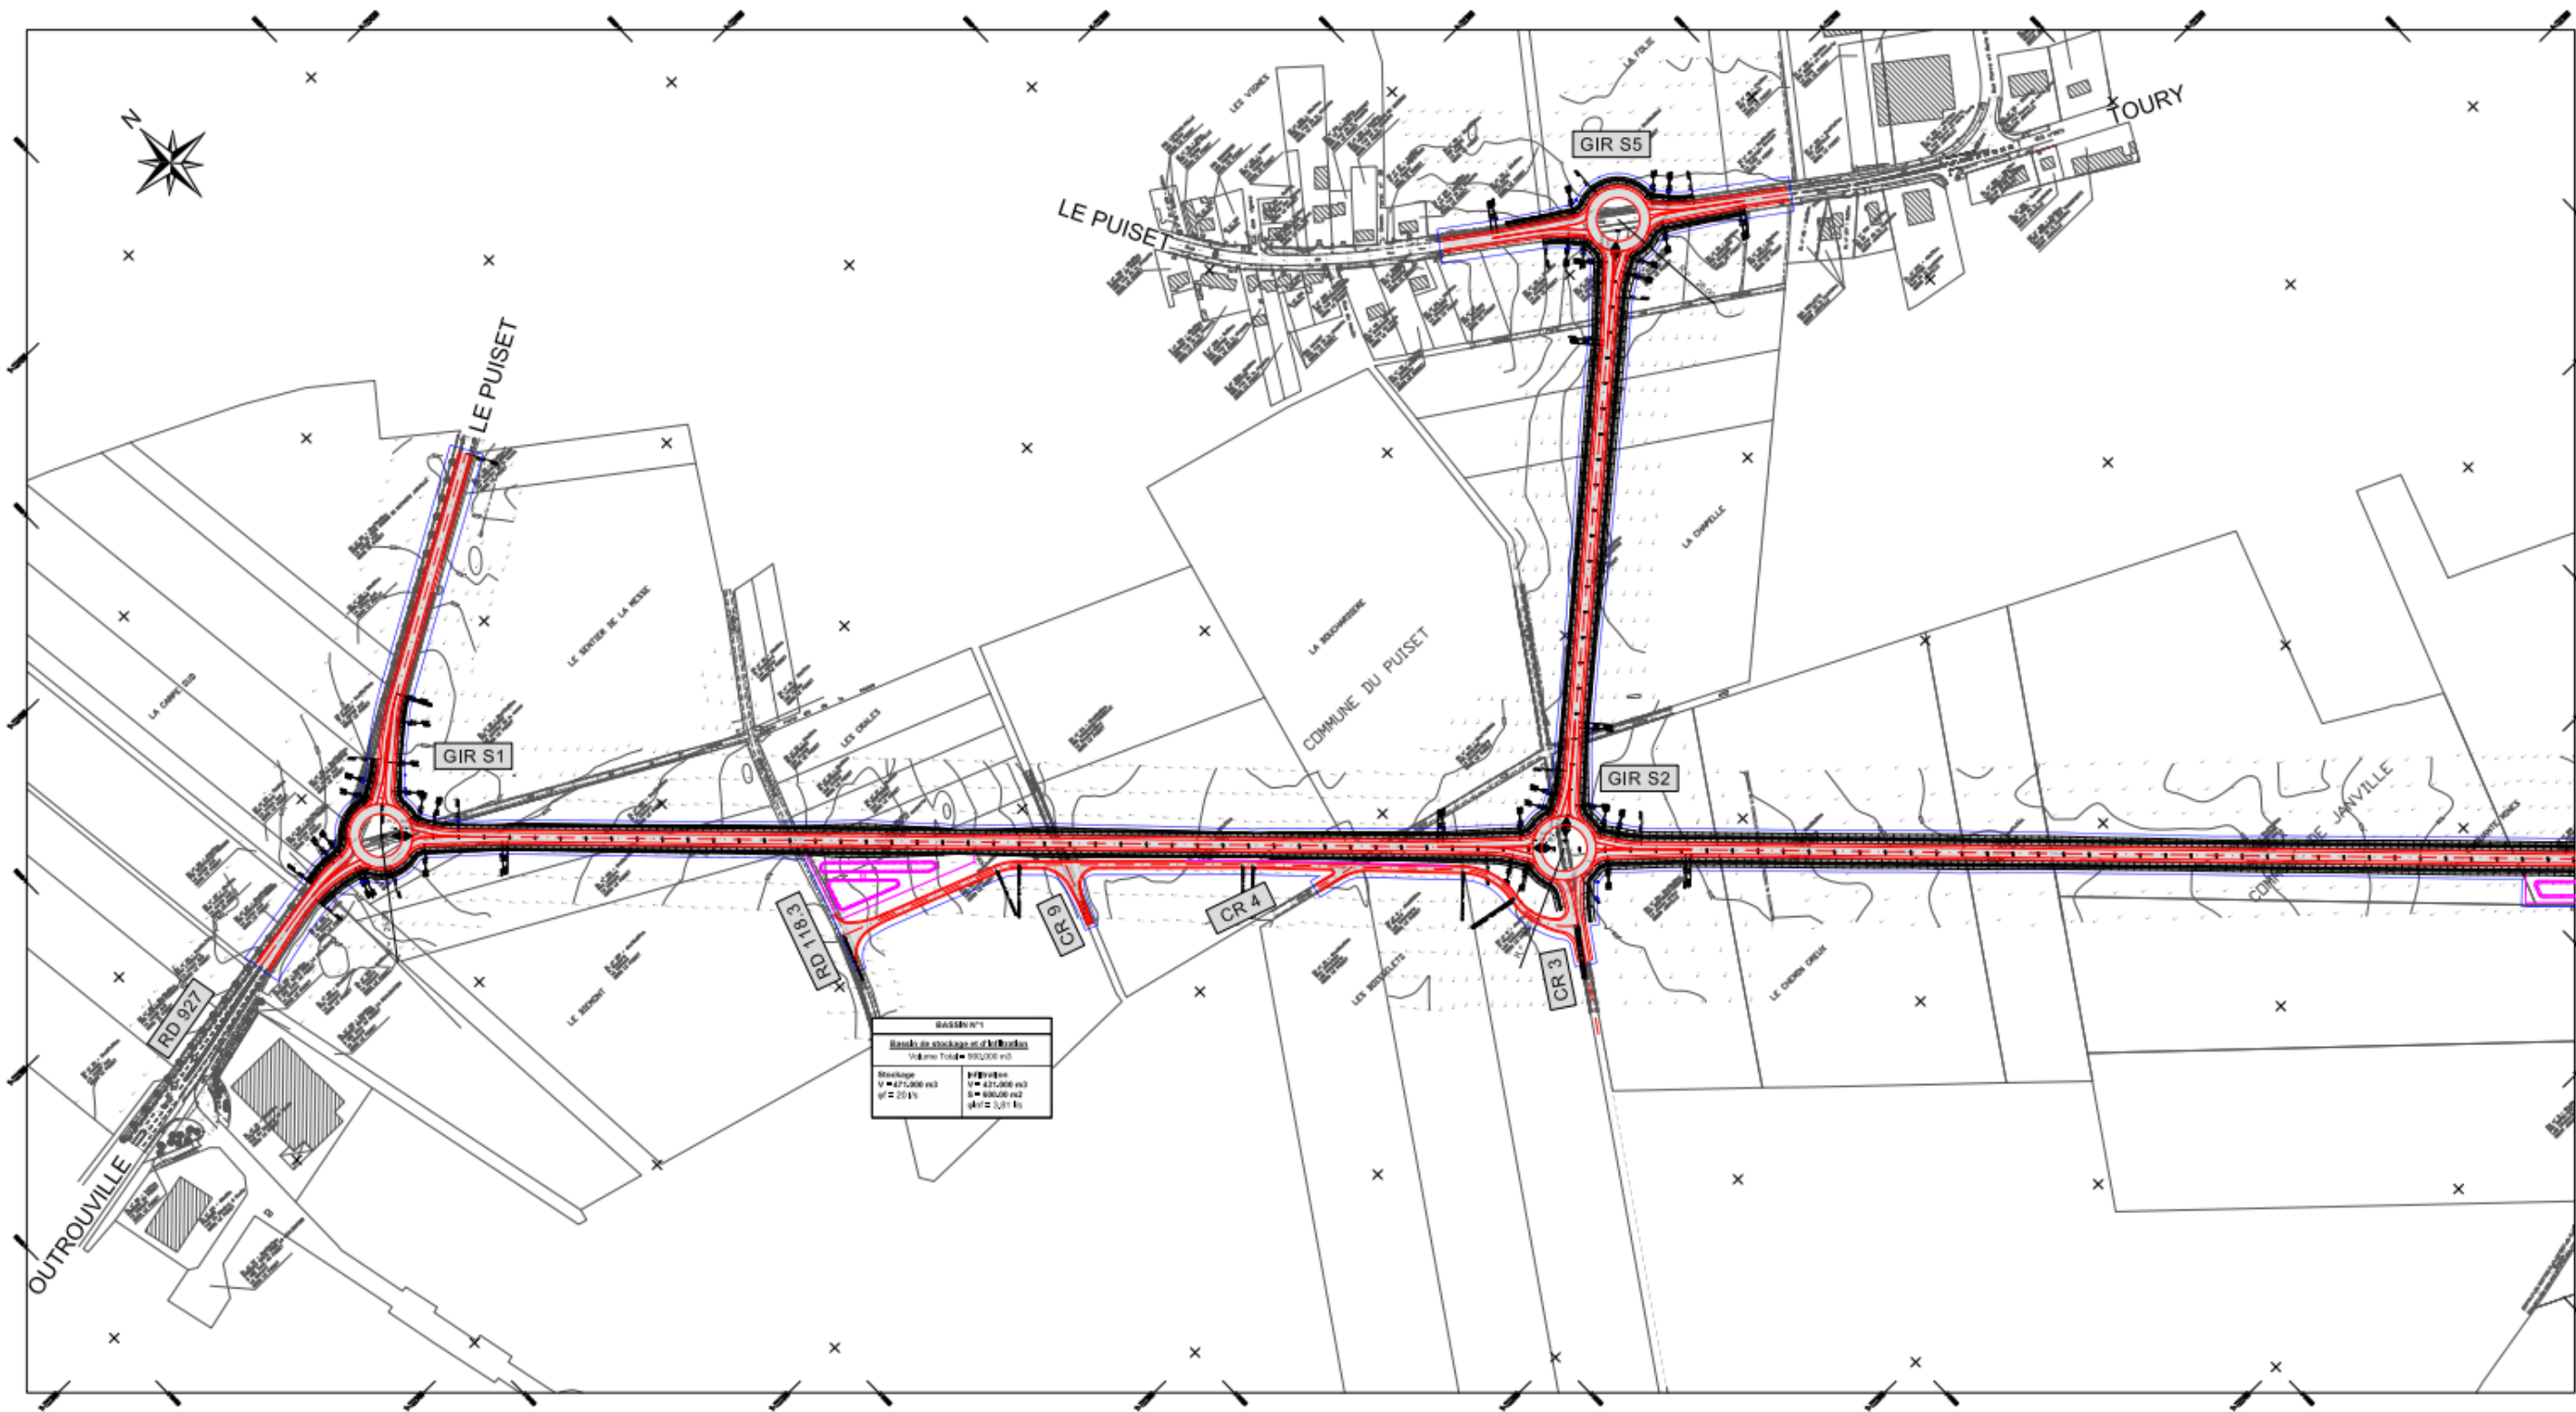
Vue en plan 1/4 du projet (section Le Puset-Janville)
